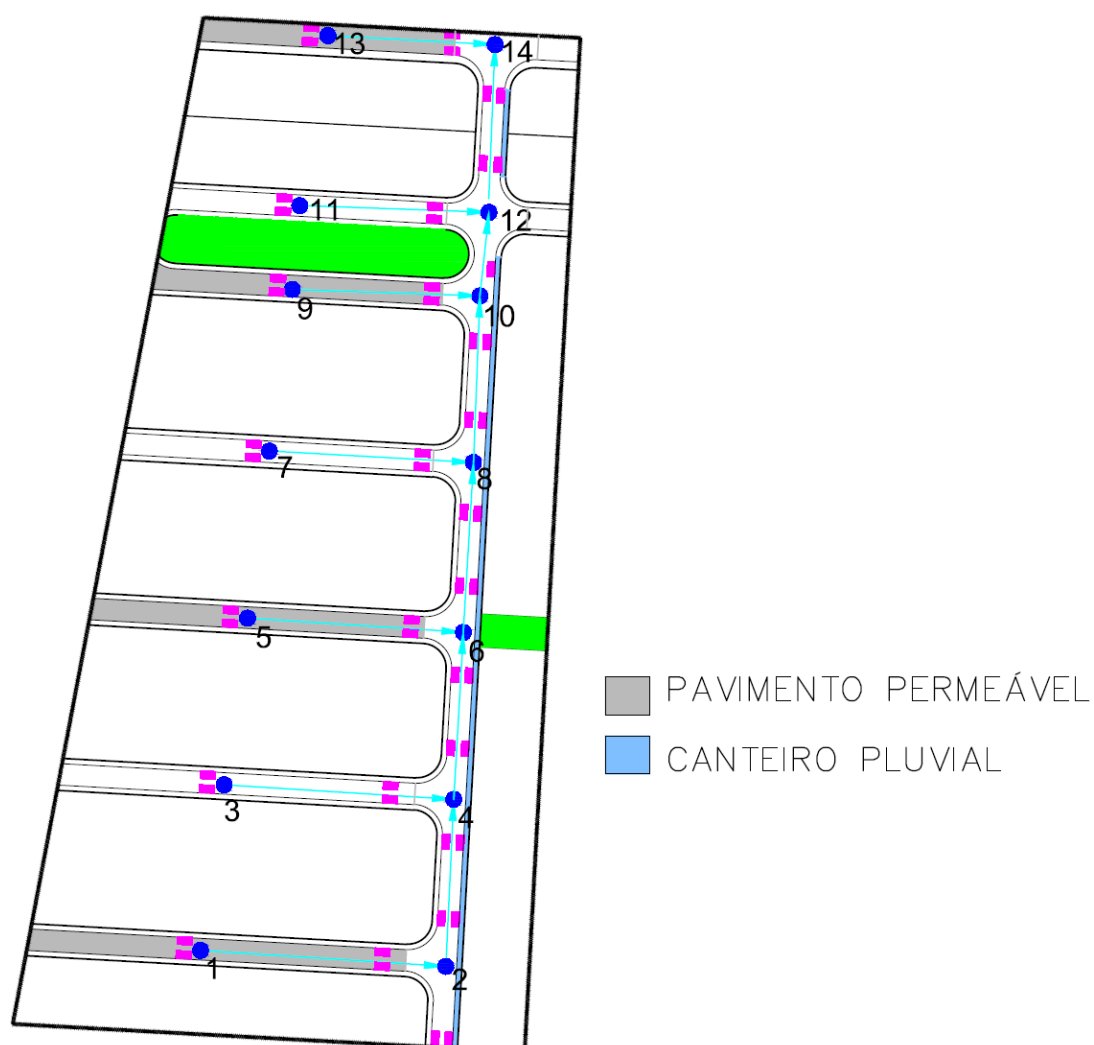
Disposição do pavimento permeável e do canteiro pluvial na área de estudo.
